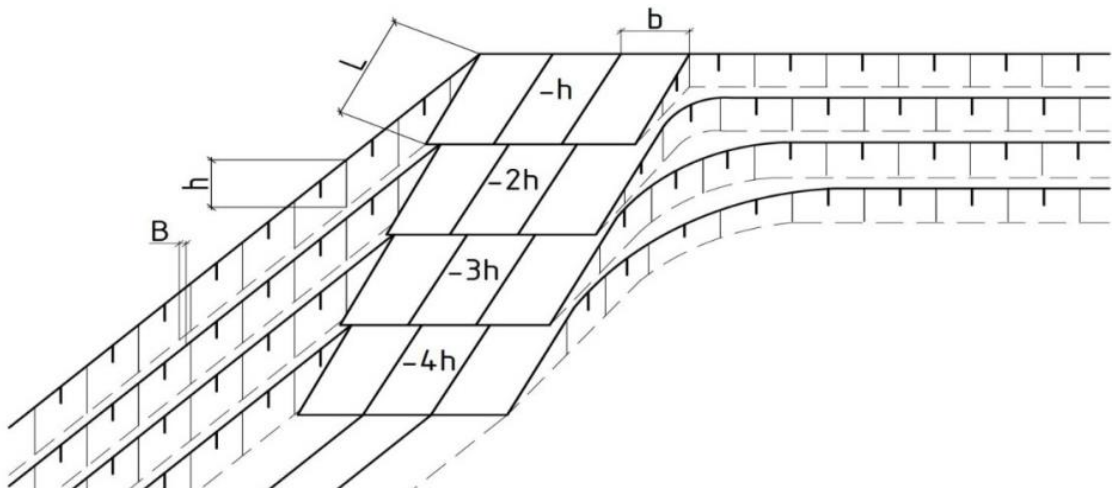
Схема проходки з'їзду фрезерним комбайном: L – довжина з'їзду;
